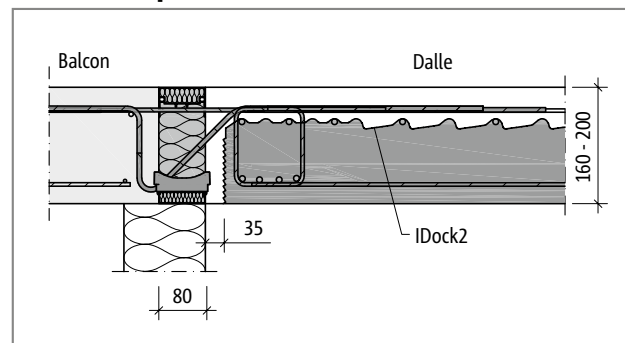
Schöck Isokorb® T Type K-E : Raccordement de balcons avec des épaisseurs de panneaux de 160 mm à 200 mm avec IDock2
